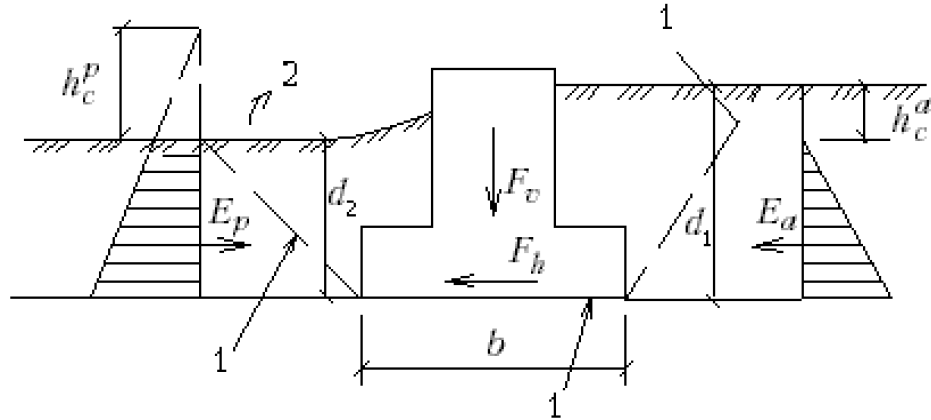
Схема до розрахунку фундаменту на зрушення по підшві: 1 – поверхня зсуву; 2 – напрямок випору ґрунту
